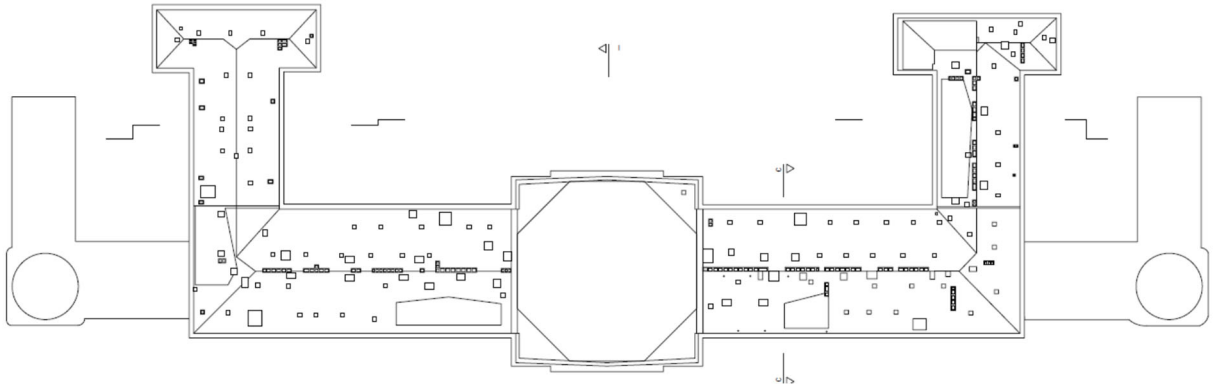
Grundriss Dachgeschoss und Dachaufsicht
